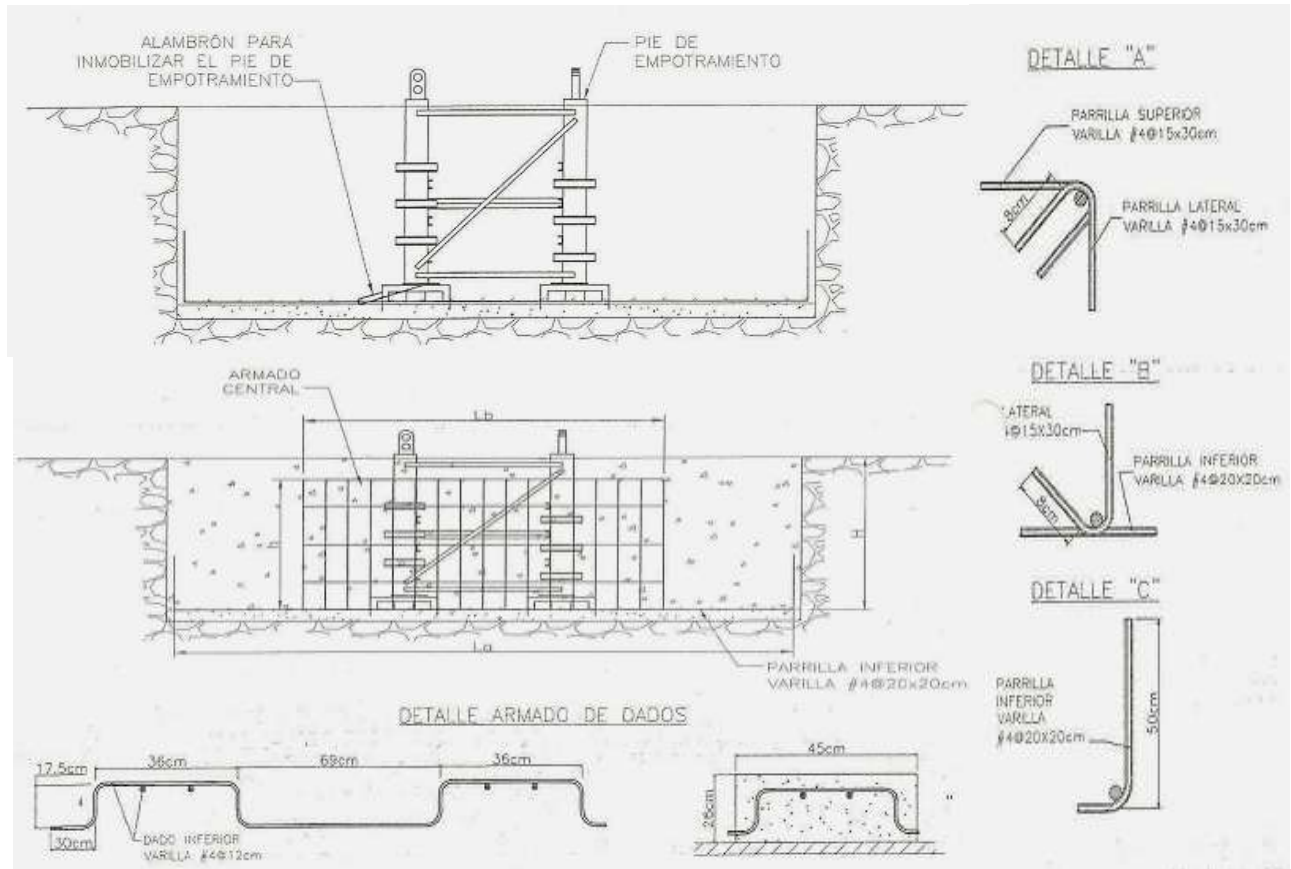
Procedimiento de Armado de la Cimentación de la Grúa Torre
